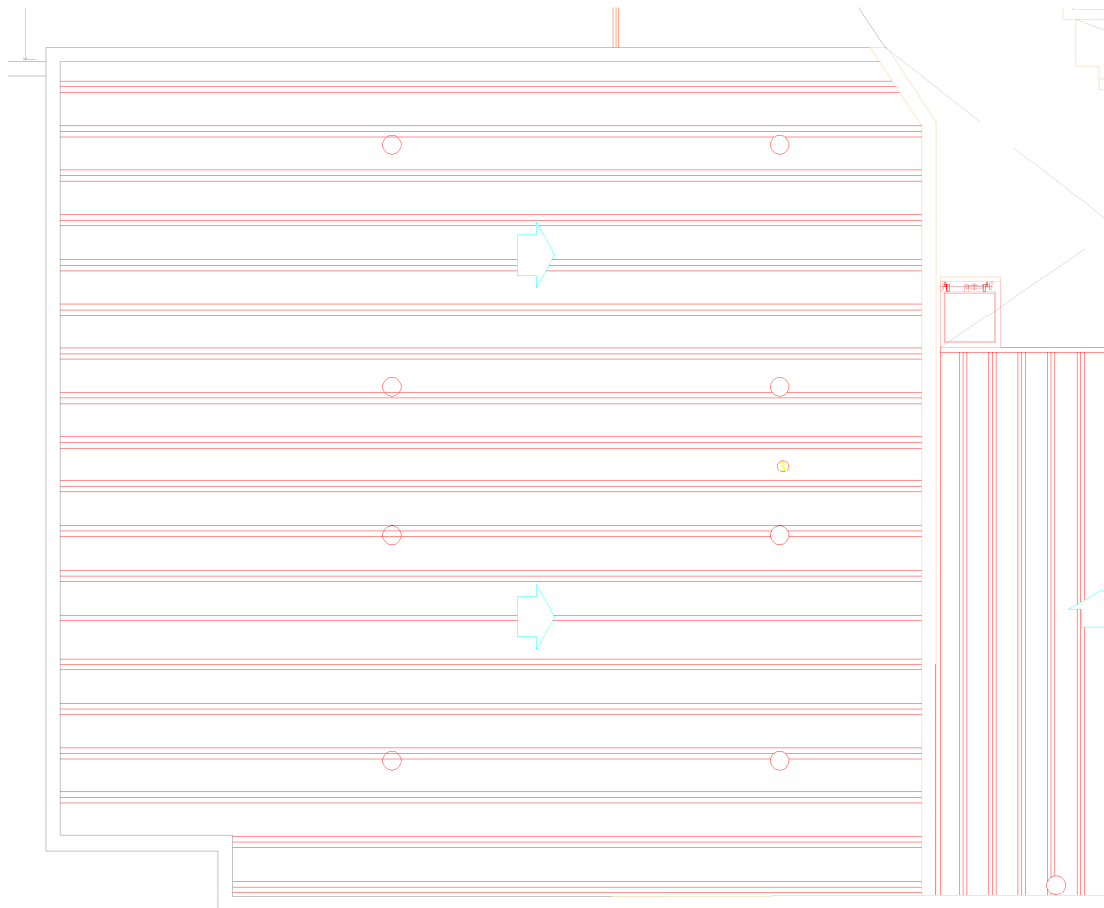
NUEVA PLANTA CUBIERTA DE TECHO – U.T.N.
